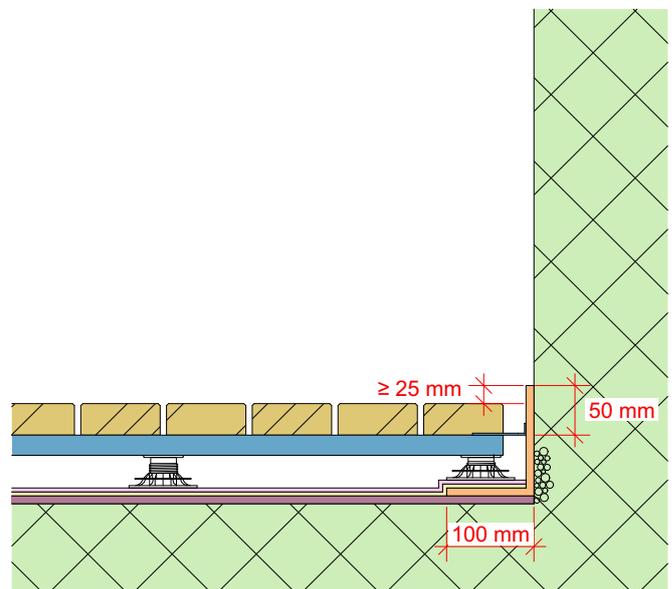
FLK-Abschluss bei einlagigen Abdichtungen auf starre Untergründe. Anschlussfläche 50 mm ab festem Untergrund z.B. über einem Kiesnest.
